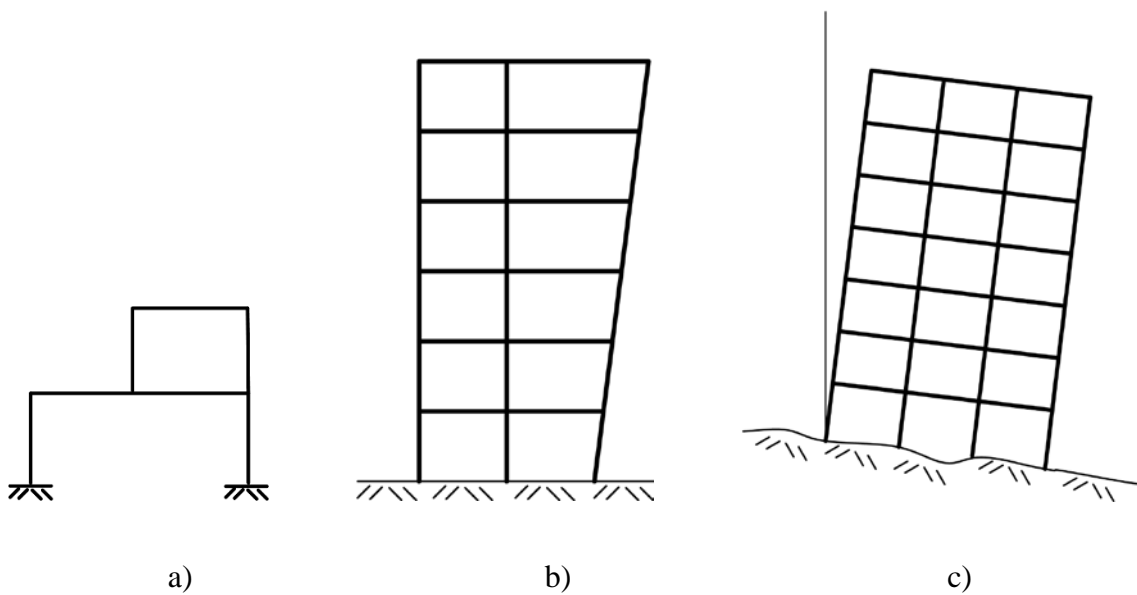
Algunos ejemplos de estructuras con asimetría en fluencia: a) asimetría en cargas verticales, b) estructuras con fachadas inclinadas, c) estructuras con desplomo.
